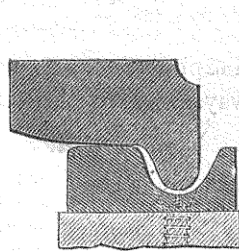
Tramways de Liège. Section du rail et du bandage d'une roue de wagon de chemin de fer. 28 kil. par mètre courant. Échelle 1/3.
